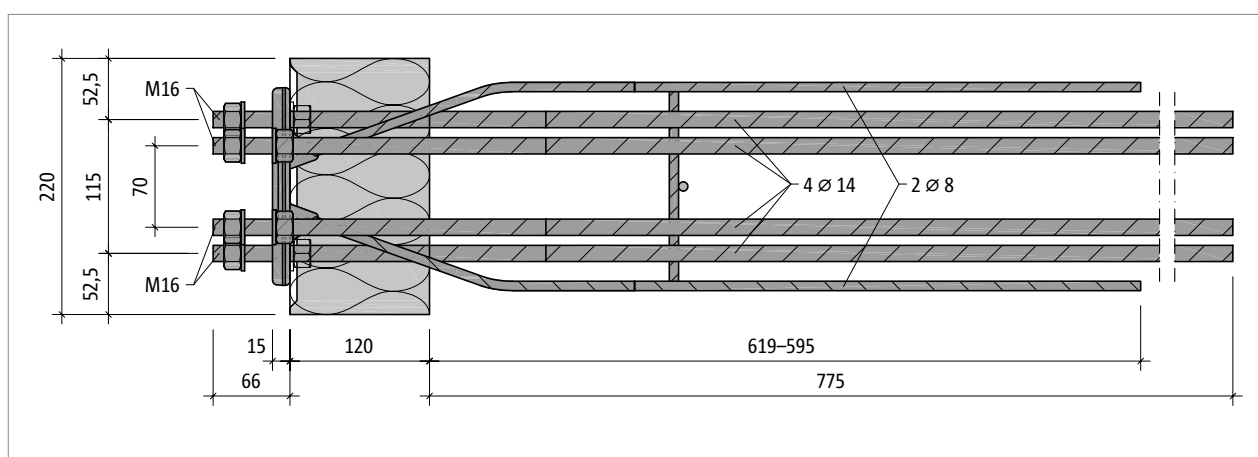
Schöck Isokorb® XT type SK-MM1-VV1 : vue en plan
